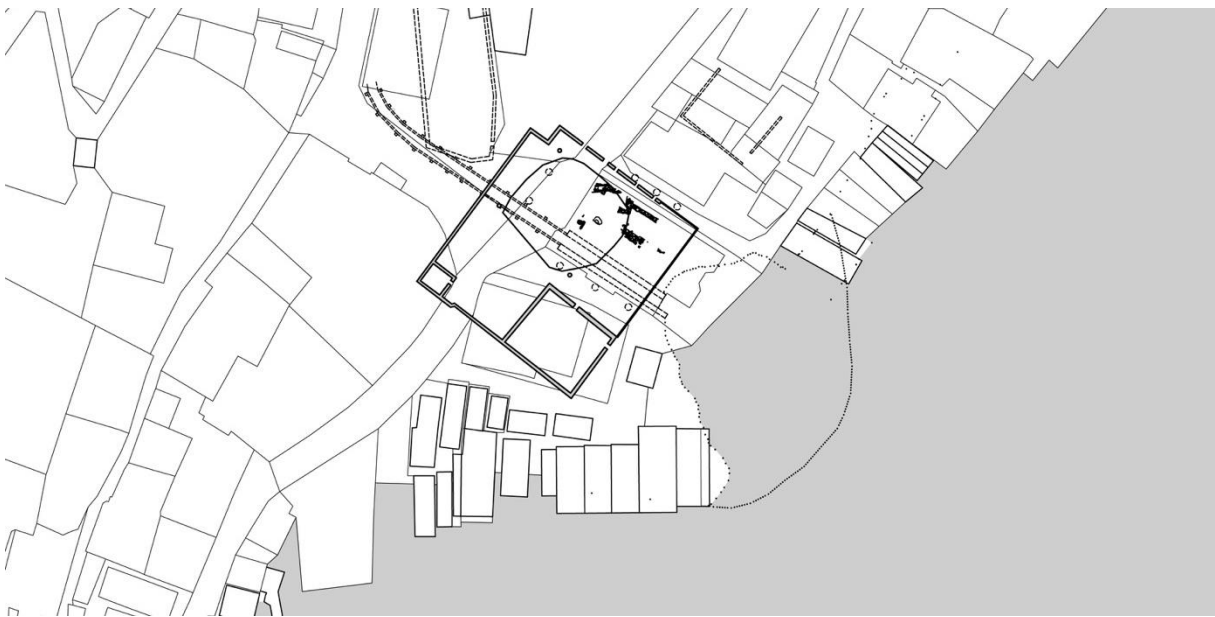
Lageplan mit rezenten Grundstücksgrenzen. Pfannhaus um 1730, Uferverlauf 1809 punktiert, Mauerreste 1809 strichliert. Zeichnung F. Idam
